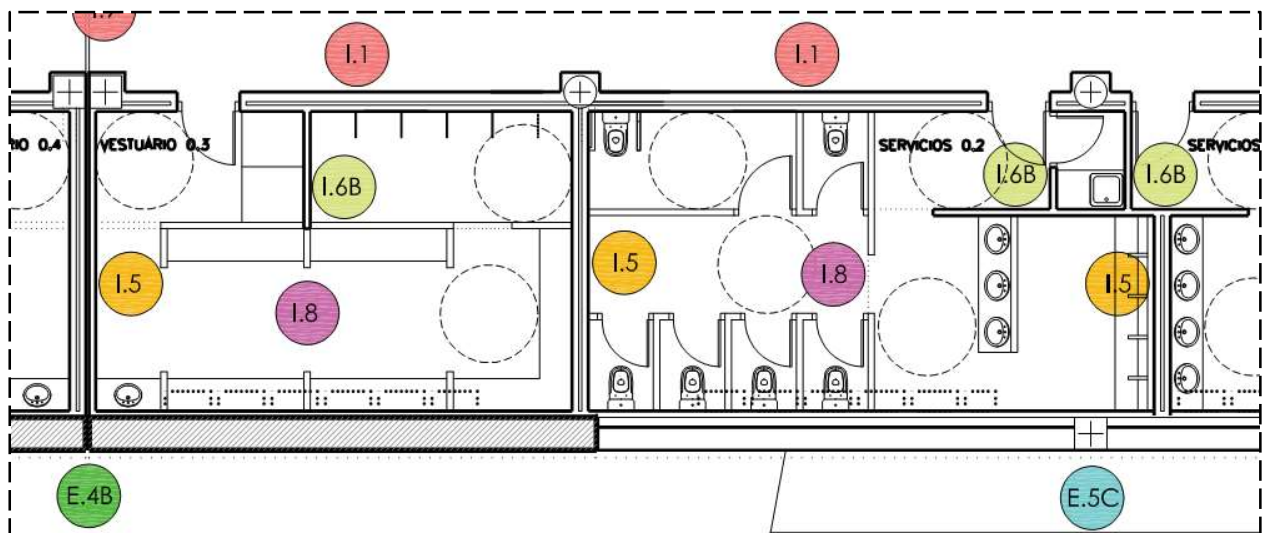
Detalle de las cámaras en vestuarios y servicios de Planta Primera. Plano RP-4 (m1)
